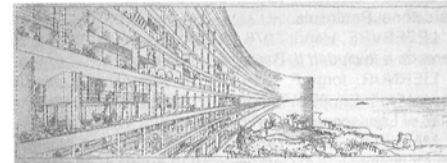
LC. Argel. Plan Obús. 1932-34. Vista de las viviendas construidas bajo el viaducto (AV 176, 2015, 67).
